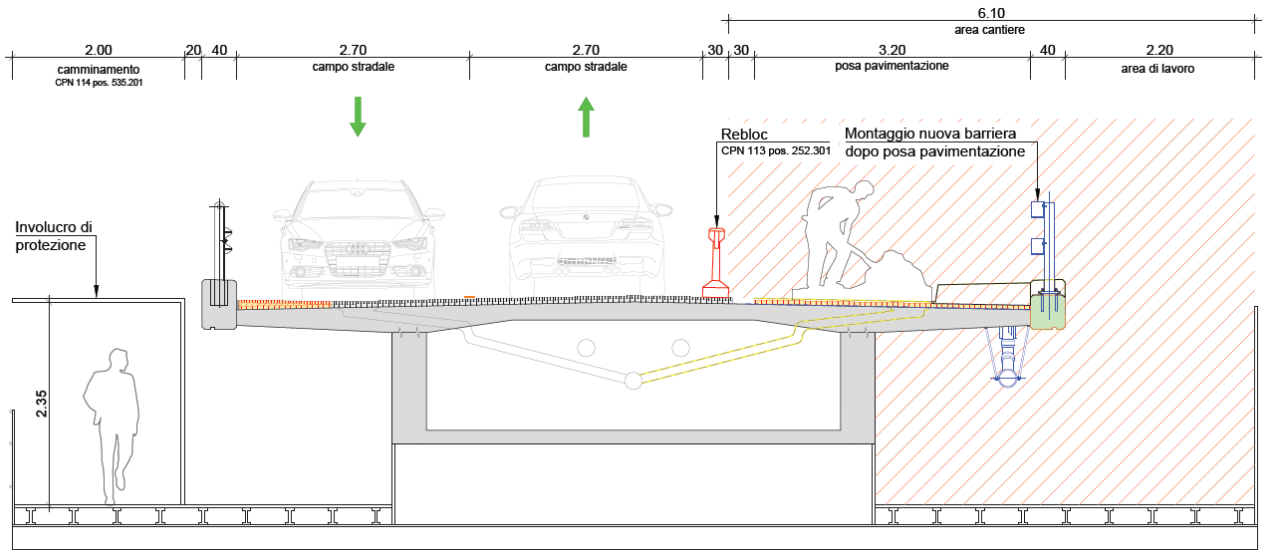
Sezione tipo con ponteggi durante le fasi di lavoro
